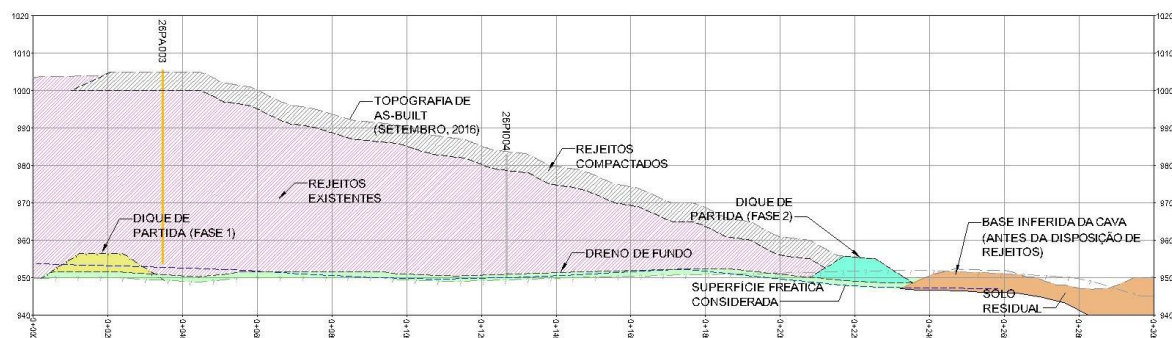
Seção típica do Empilhamento Drenado da Cava de Germano. (NORWEST 2017, Projeto As Is, G122610-O-100008).
